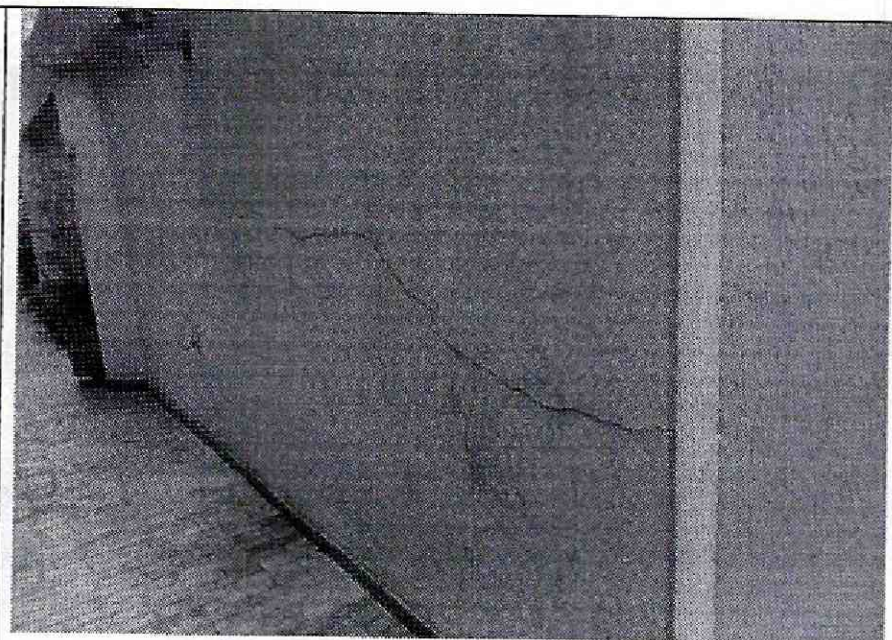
Grieta en la parte central del muro de lindero.
